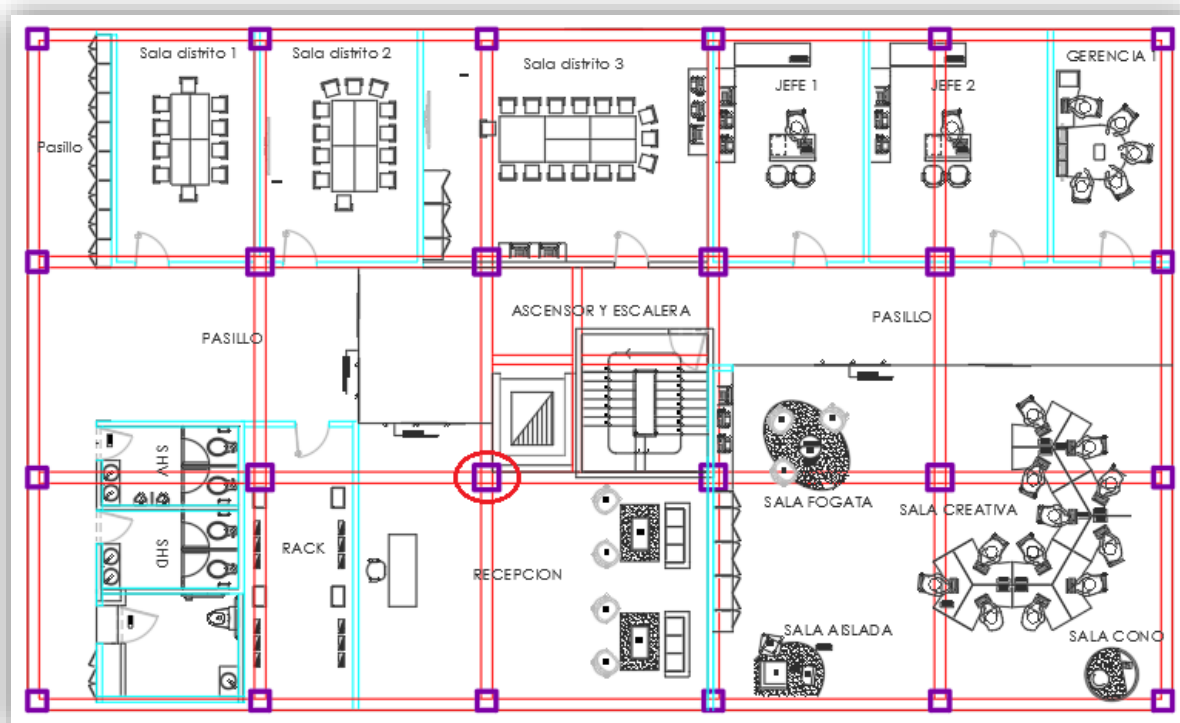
Detalle de viga que se apoya en otra viga
